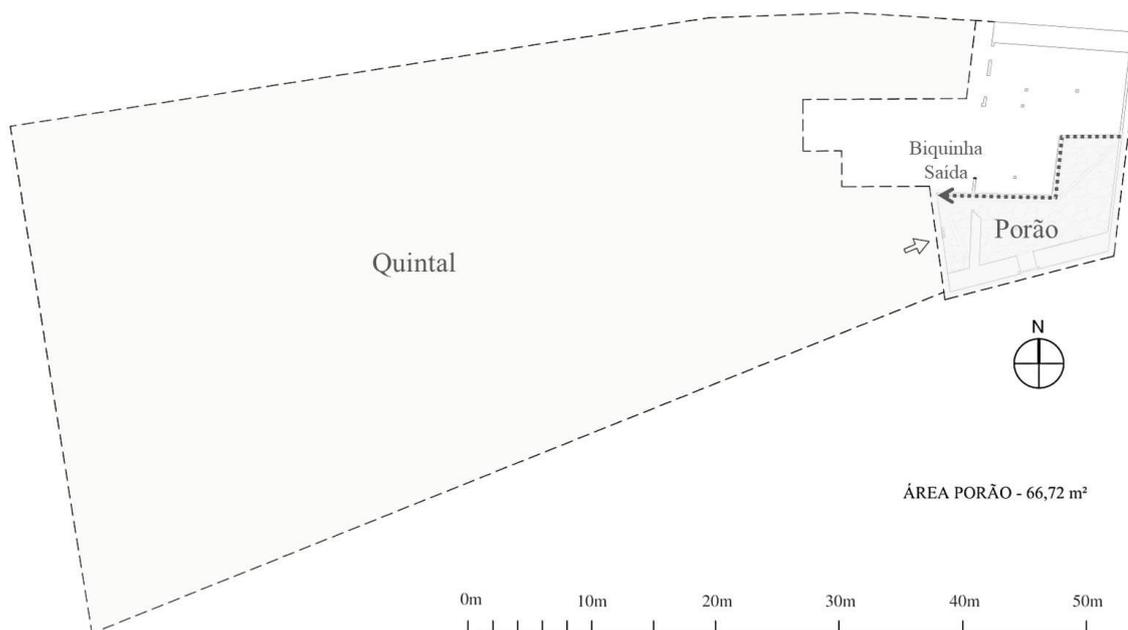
Planta baixa Porão - Museu Casa de Cora. Disponível em: Levantamento Cadastral Arquitetura Museu Casa de Cora, ETEC I – IPHAN/GO. Zoneamento feito pela autora.
